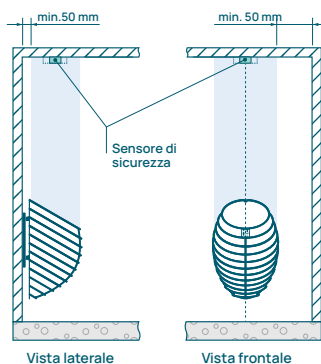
Installazione del sensore di sicurezza a soffitto: riscaldatore a parete
